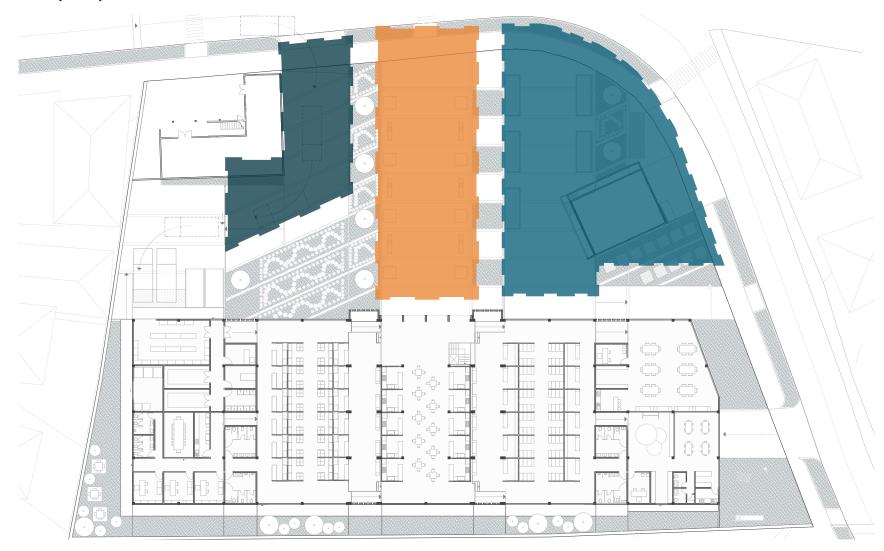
Planta general de la plaza. Fuente: Autores, 2024
